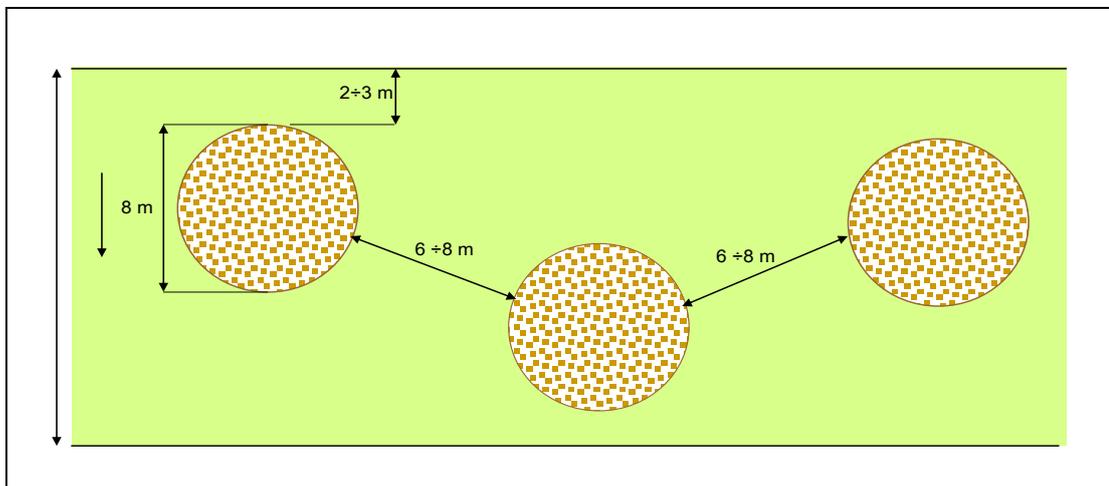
/A - Schema della disposizione planimetrica delle isole vegetazionali all'interno dell'area di passaggio
